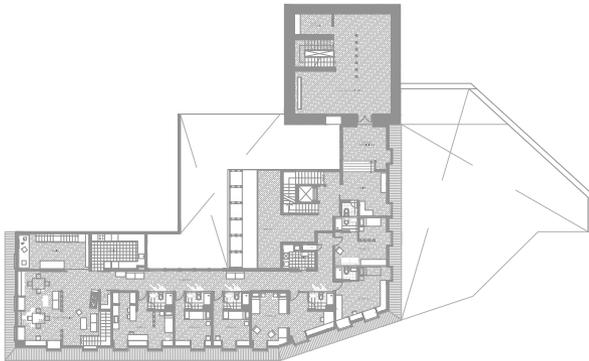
Planta 3er nivel, Centro Extensión GAL_212
